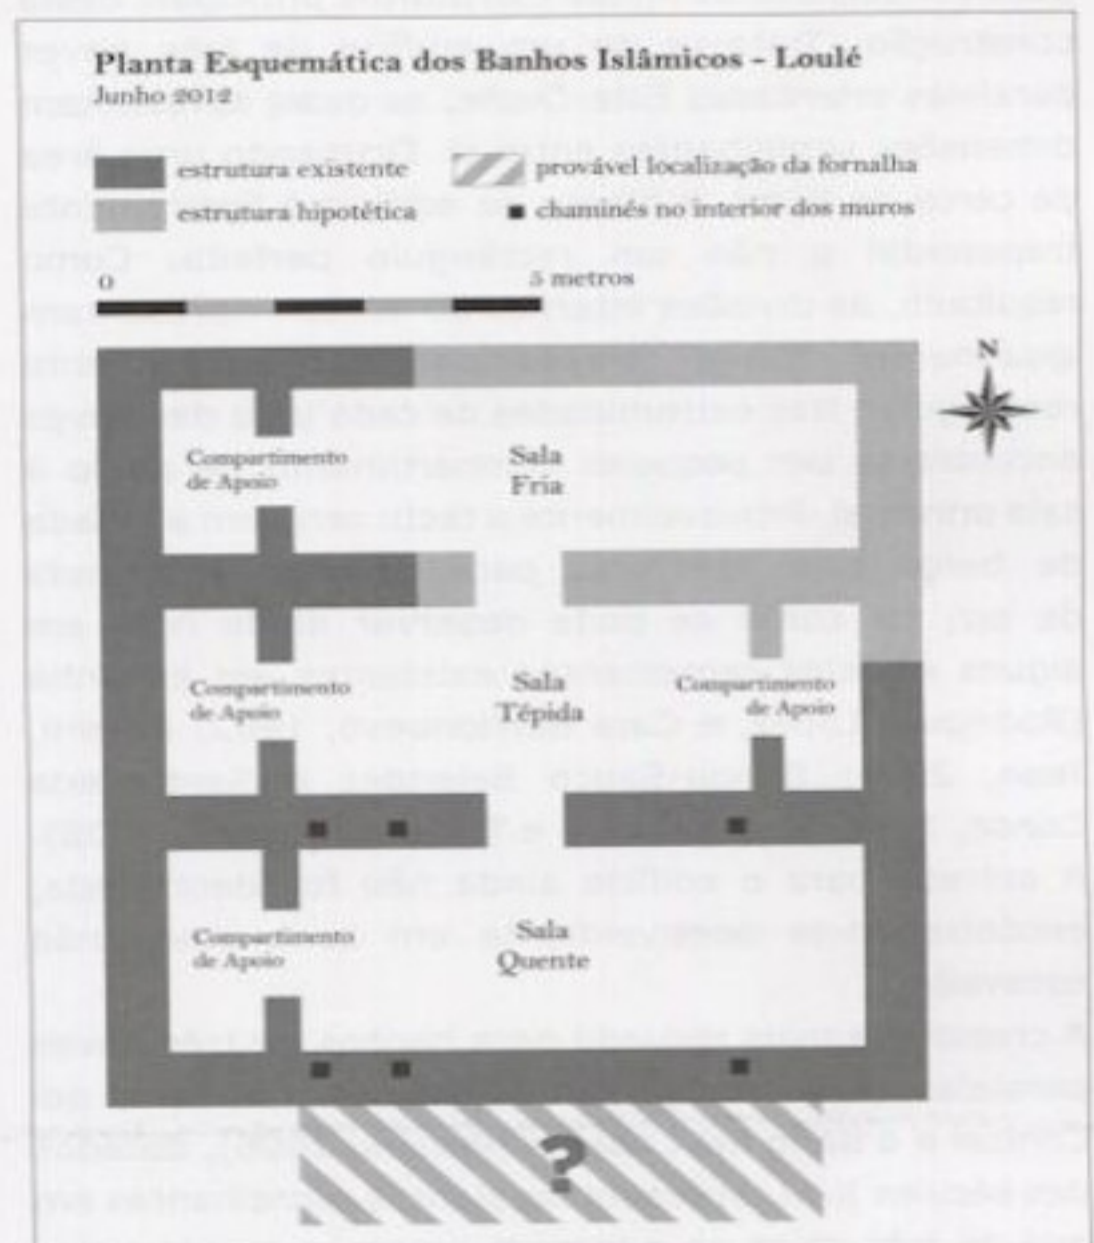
Planta esquemática do edifício dos Banhos Islâmicos
